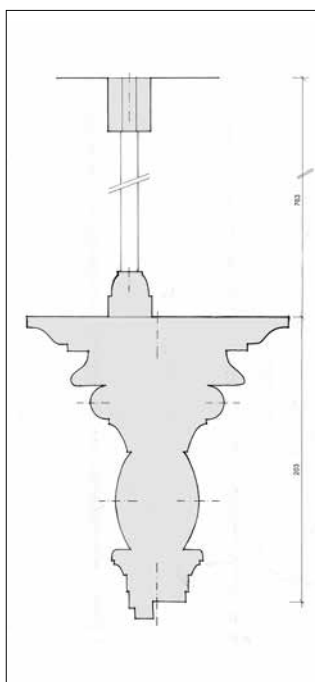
Praha 1-Hradčany, čp. 169, Úvoz 6. Detail prvku č. 1, lavičnick (foto P. Havlík, 2014).
